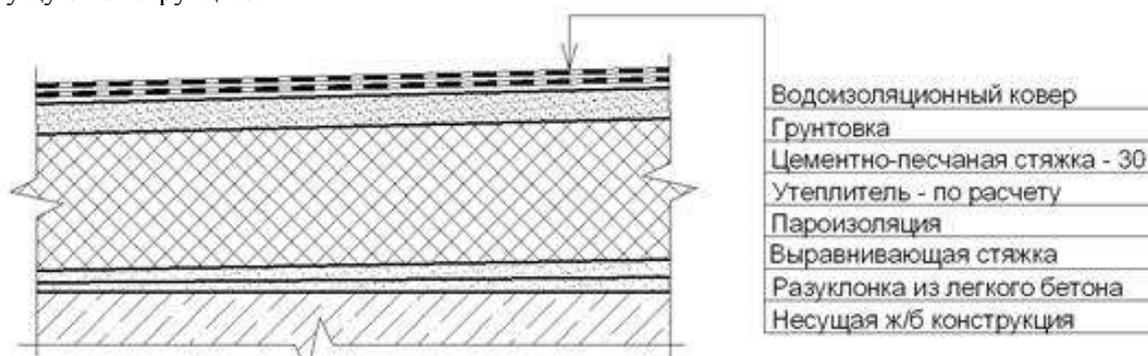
Состав кровли по несущей железобетонной конструкции 1
